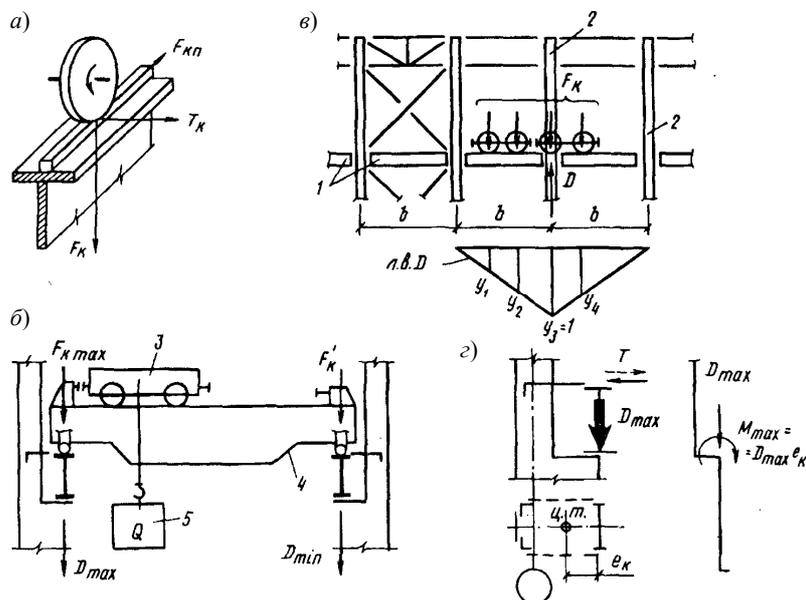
К определению нагрузок на раму от мостовых кранов:
